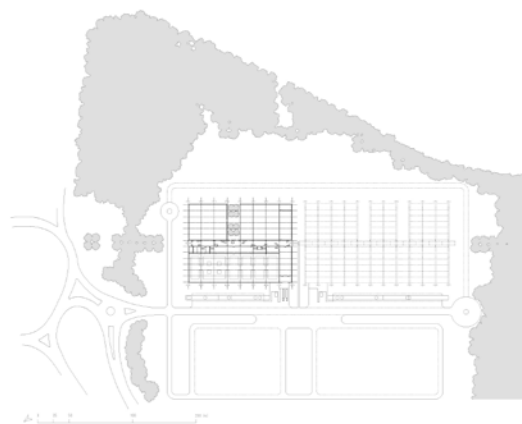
Plano de la planta de distribución de la fábrica Imos. Fuente: Elaboración propia.
